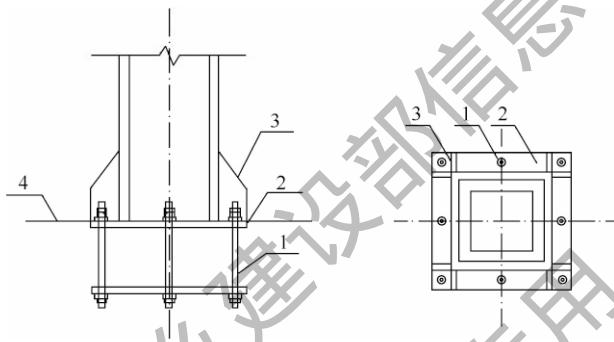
矩形钢管混凝土柱非埋入式柱脚
